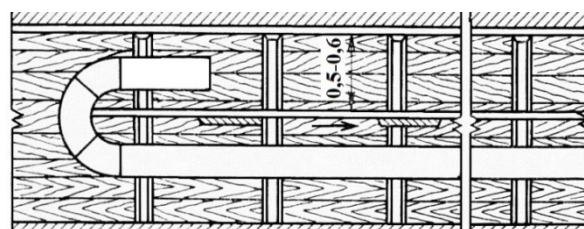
Схема применения продольной перегородки для ликвидации слоевого скопления метана
